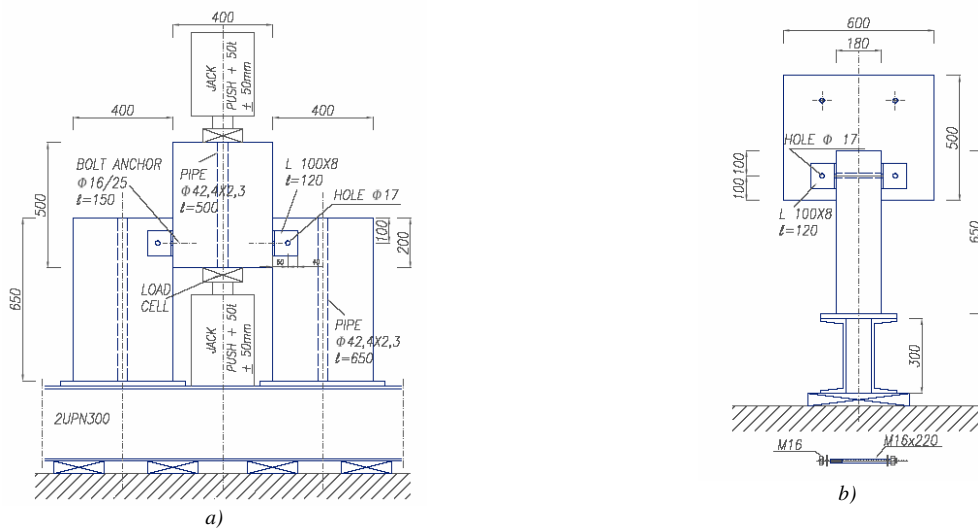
Impianto per la prova preliminare: a) vista frontale; b) vista laterale
